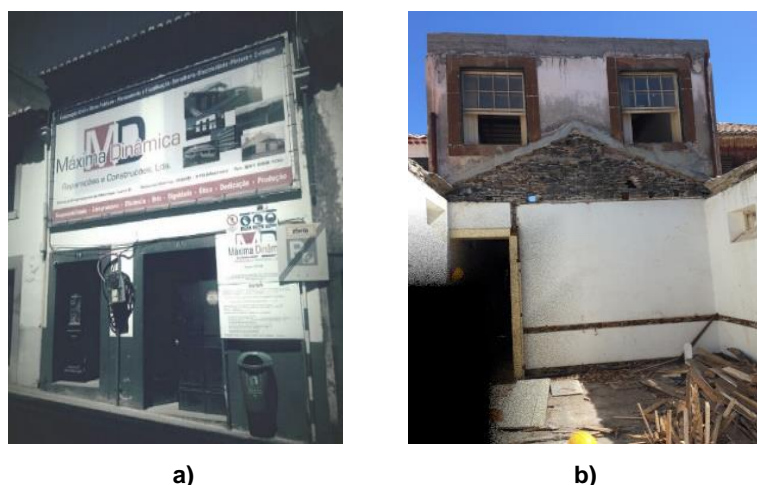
a) Fachada principal do edifício original b) Torre central do edifício
